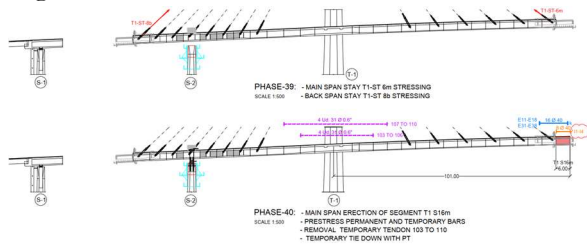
Esquema estructural previo a conexión en pilas intermedias.
